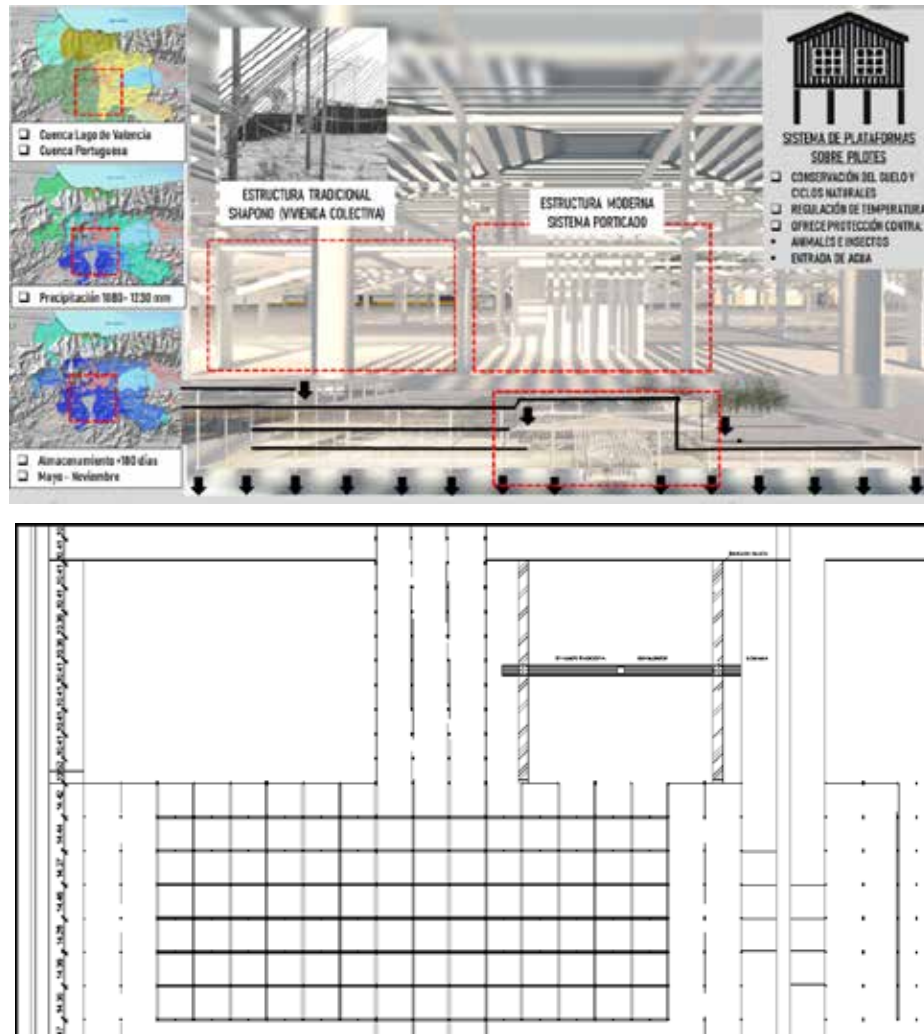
Sistema Estructural. Fuente: Schaverin (2021)
